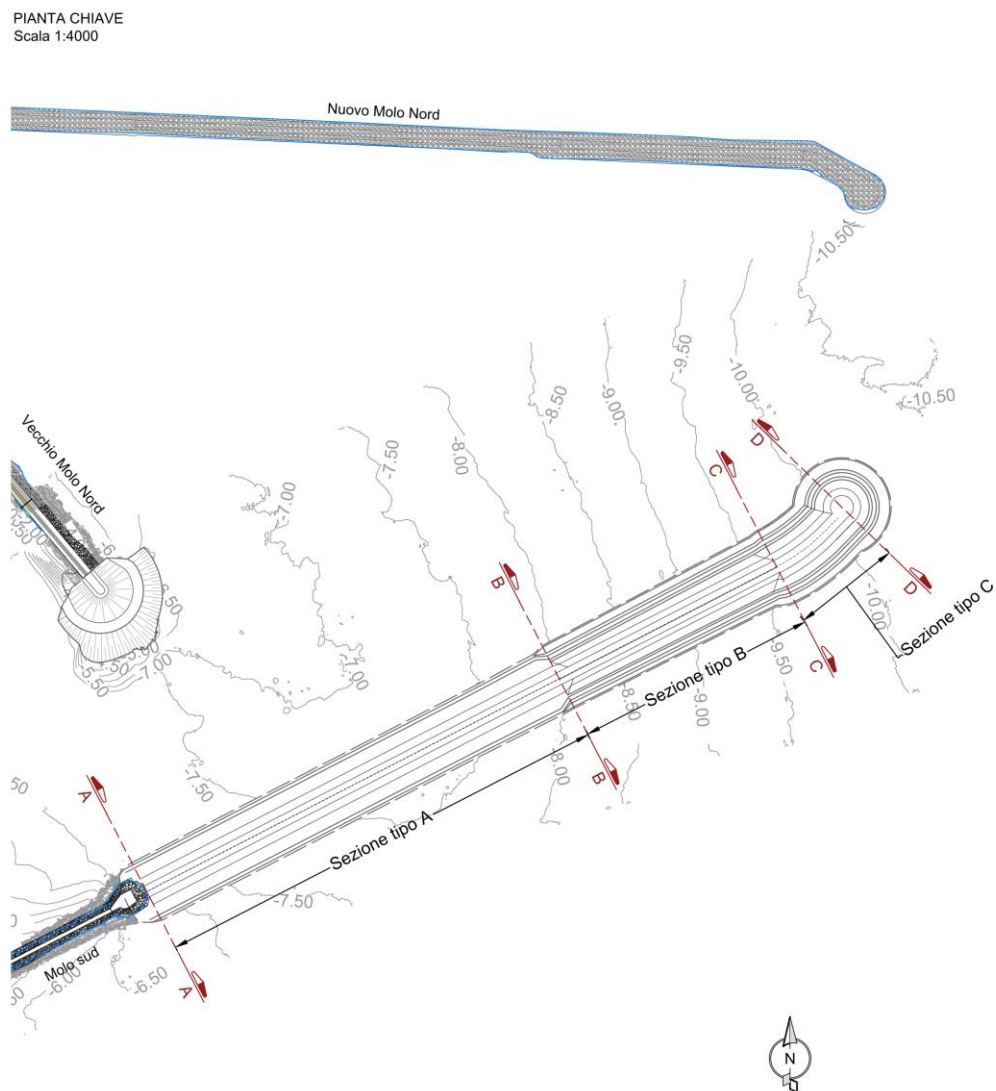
Planimetria delle sezioni per il prolungamento della Diga Foranea Sud
